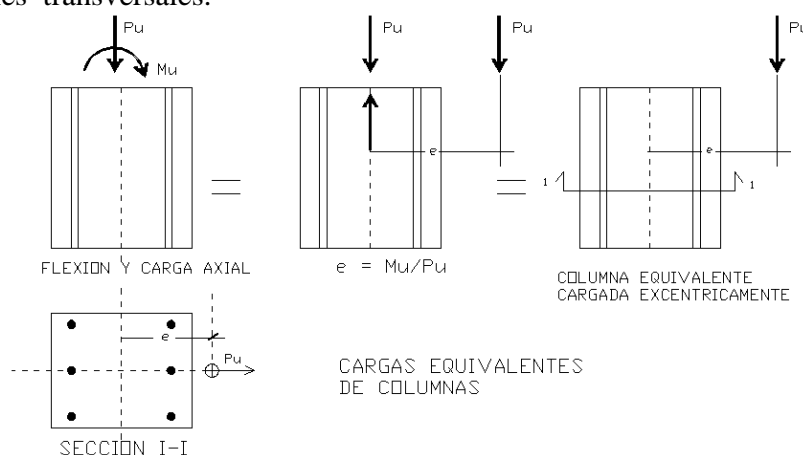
Efecto de Flexo compresión en Columnas.
